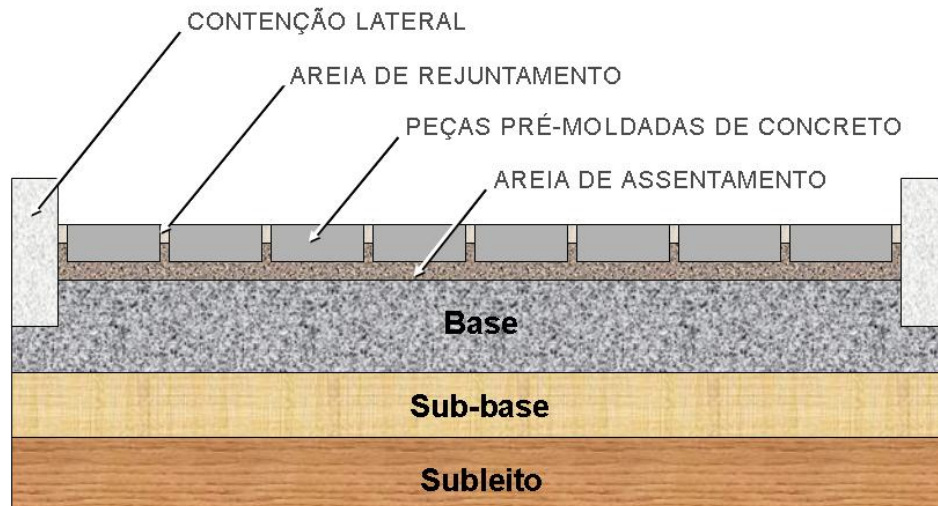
Estrutura típica de um pavimento intertravado (HALLACK, 1998)
